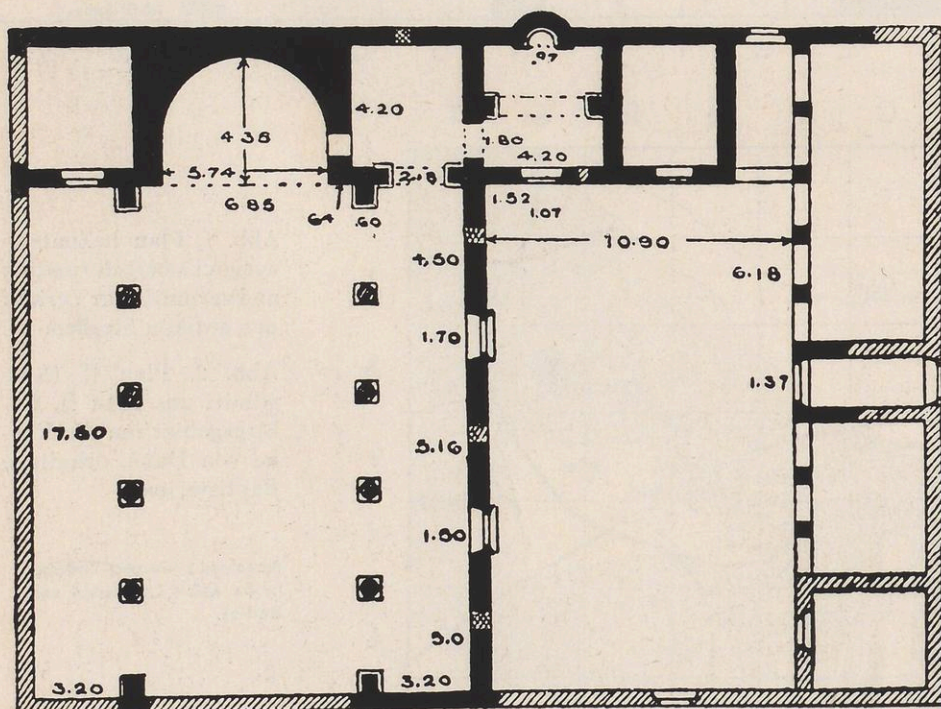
Grundriß von Ksédjbeh (nach Butler)
